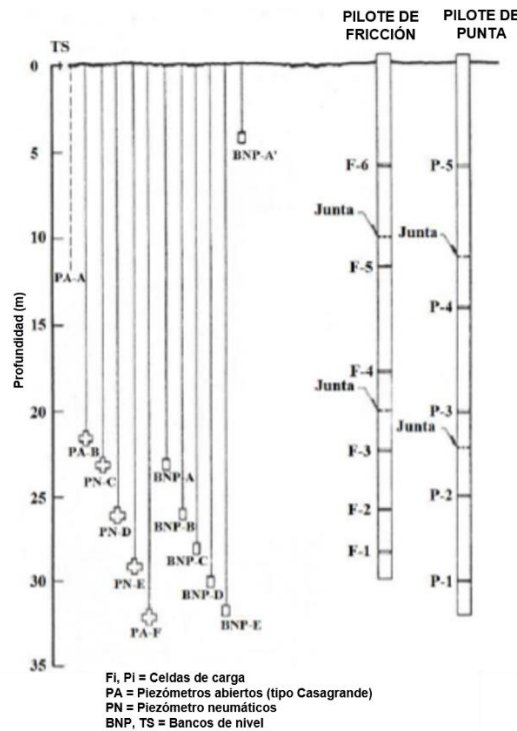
Instrumentación para prueba de pilotes (Auvinet y Hanell, 1981)
